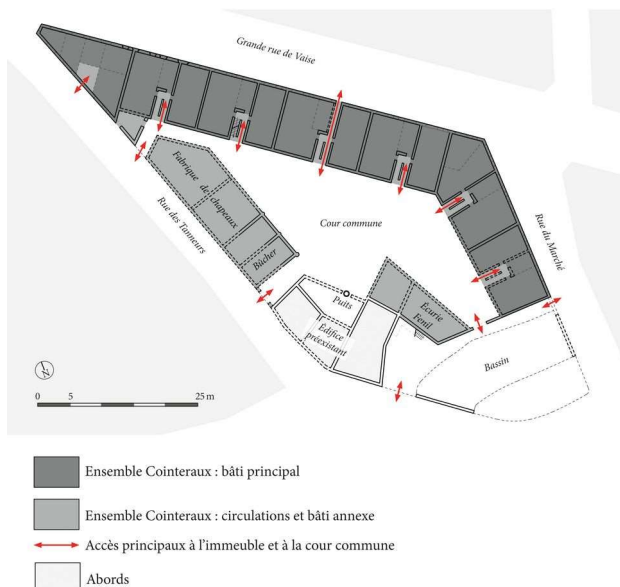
Dispositions supposées de l'ensemble Cointeraux de Vaise en 1789, plan de rez-de-chaussée. Plan : E. Mille, in : Delavenne, Mille, 2022.
